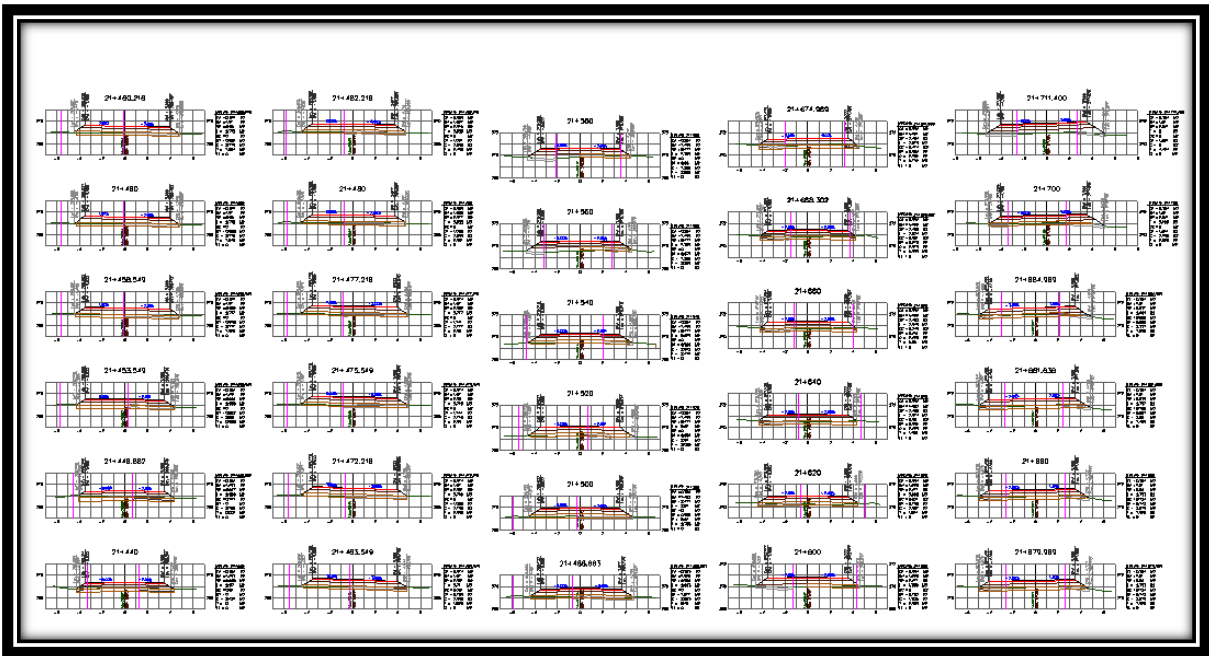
Secciones de construcción del km 21+440.000 al km 21+711.400.
